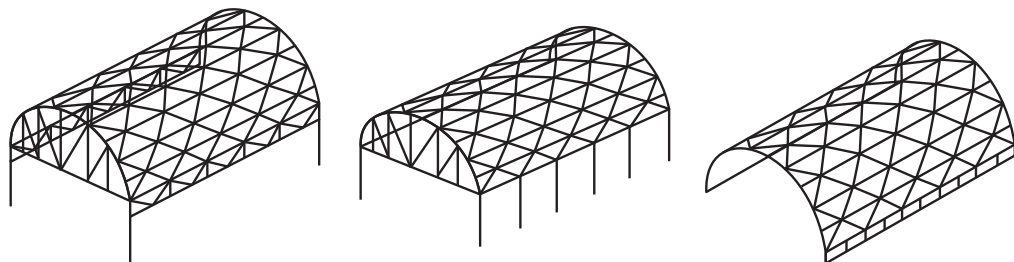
Схемы опирания цилиндрических оболочек: а) на угловые колонны; б) на промежуточные стойки; в) на ленточные фундаменты
